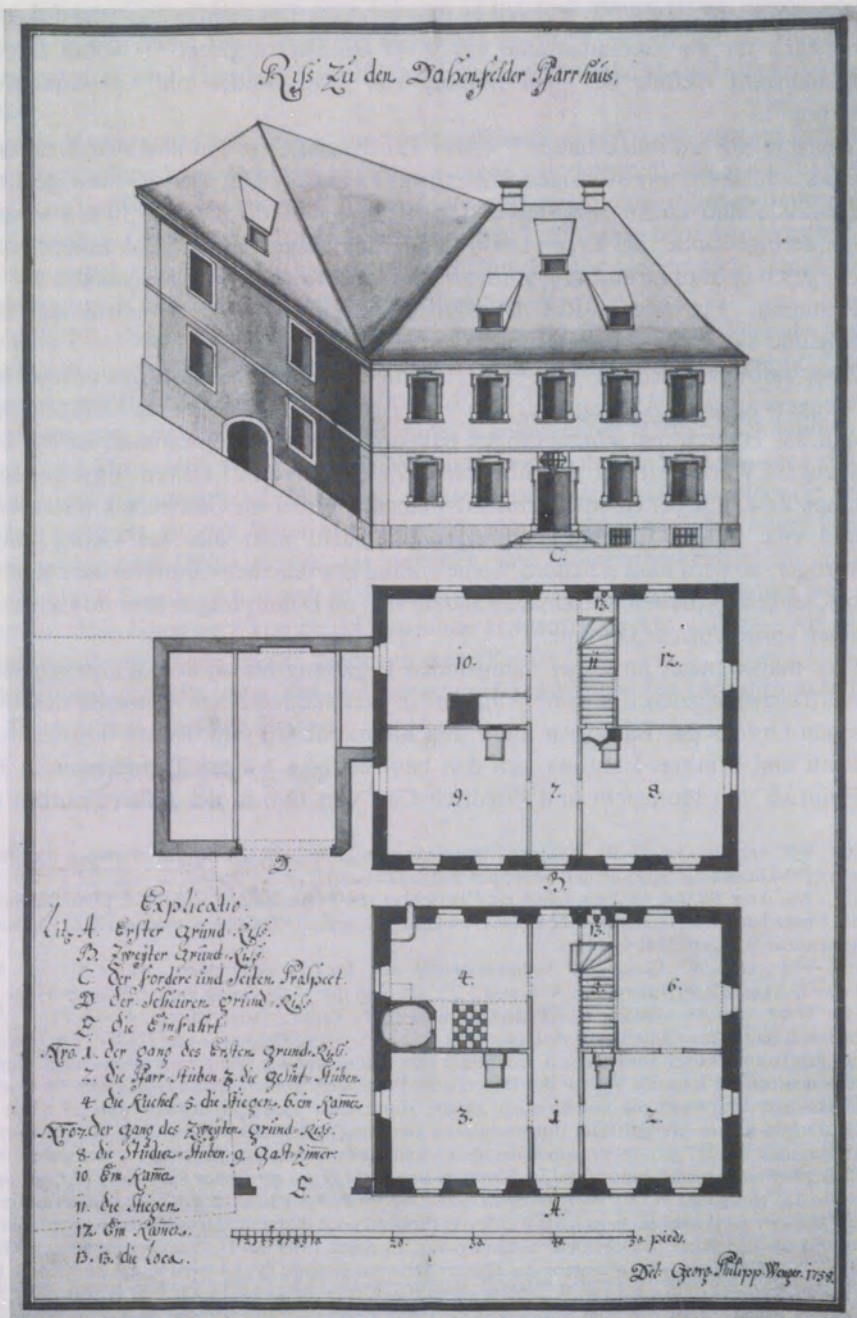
Ansicht und Grundrisse für das geplante Dahenfelder Pfarrhaus.
